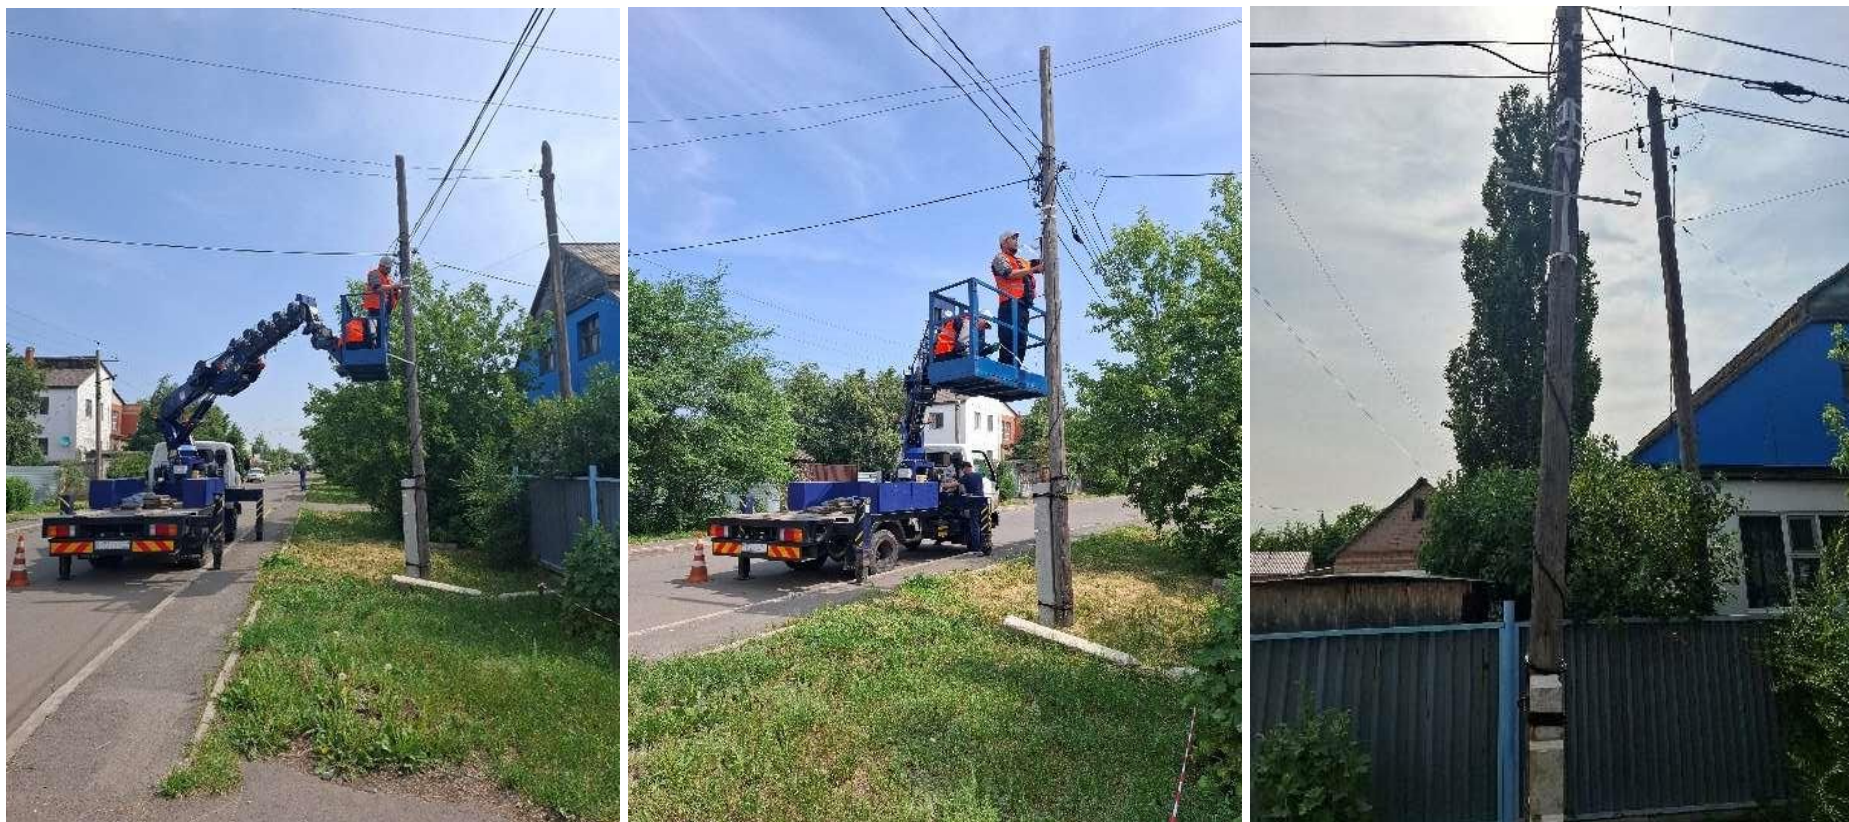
Установка узла крепления натяжной (кронштейна) и устройства для подвеса муфт и запаса кабеля
